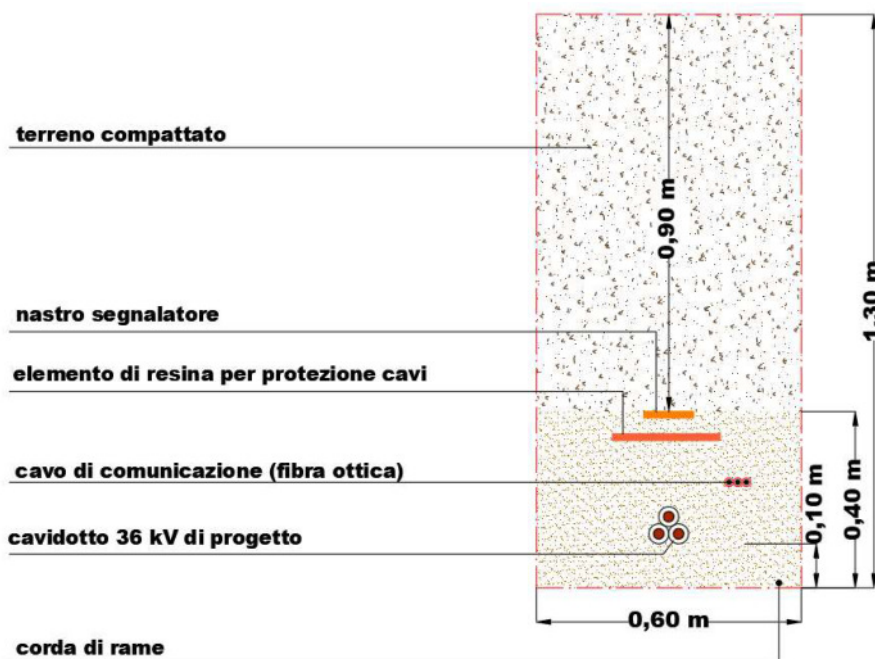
Sezione Cavidotto Singola Terna su Terreno
